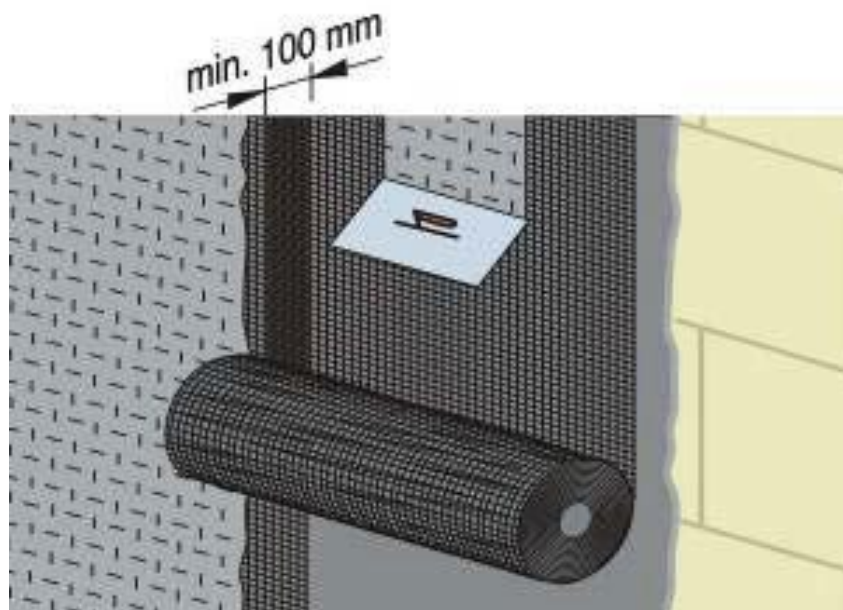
Způsob vyztužení exponovaných míst u stavebních otvorů [57]
